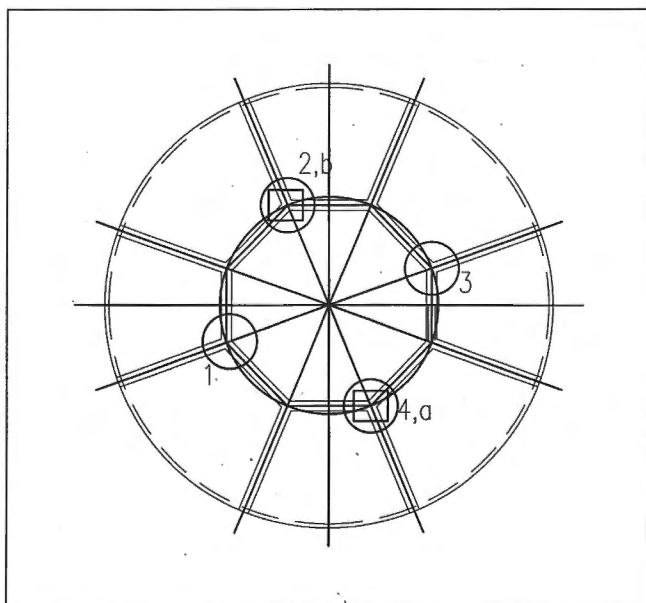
Indikátorové hodinky pro měření nadzvednutí desky na jejím dolním povrchu / Surface indicator for measuring deflections on the low surface of slab
